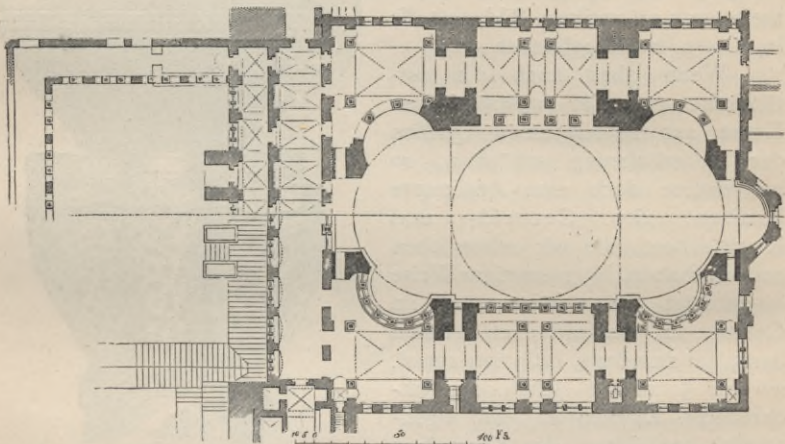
Grundriss der Sophienkirche zu Konstantinopel.
